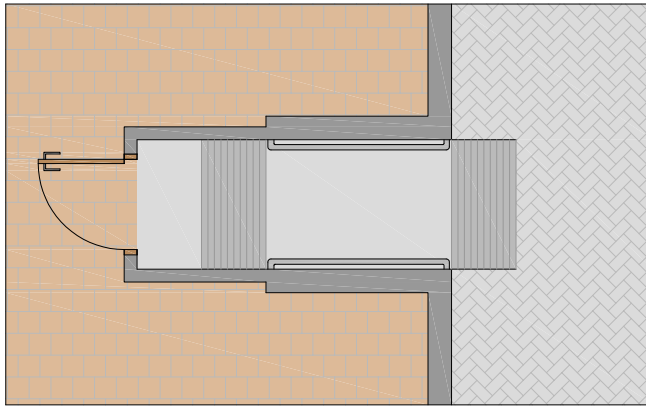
Vista en planta de un punto de entrada a distinto nivel.
